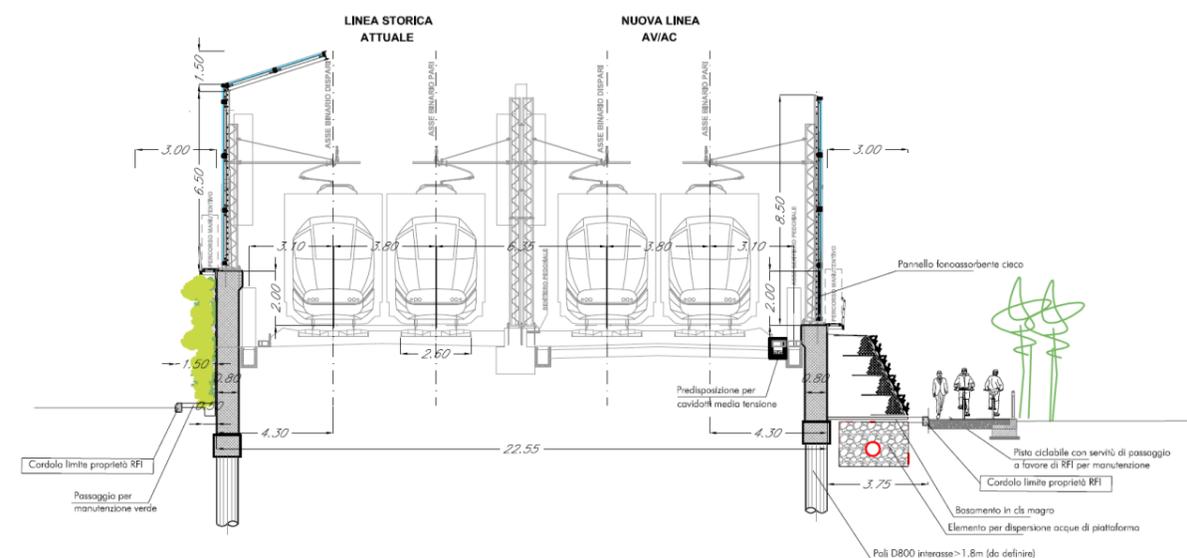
Sezione tipo in corrispondenza del tratto urbano di Brescia
